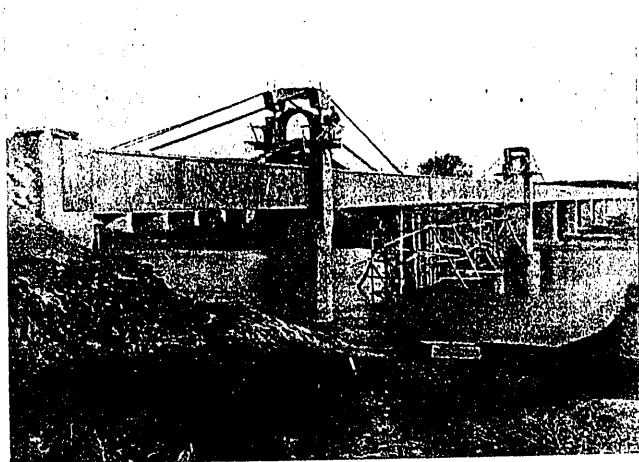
ª Vista general del puente, antes del descimbramiento.
